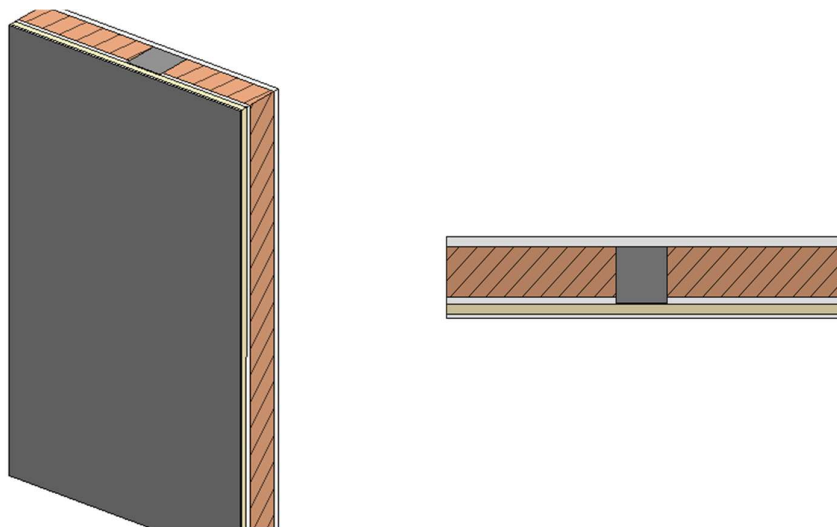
Vista en 3D y en planta del Muro 5.
